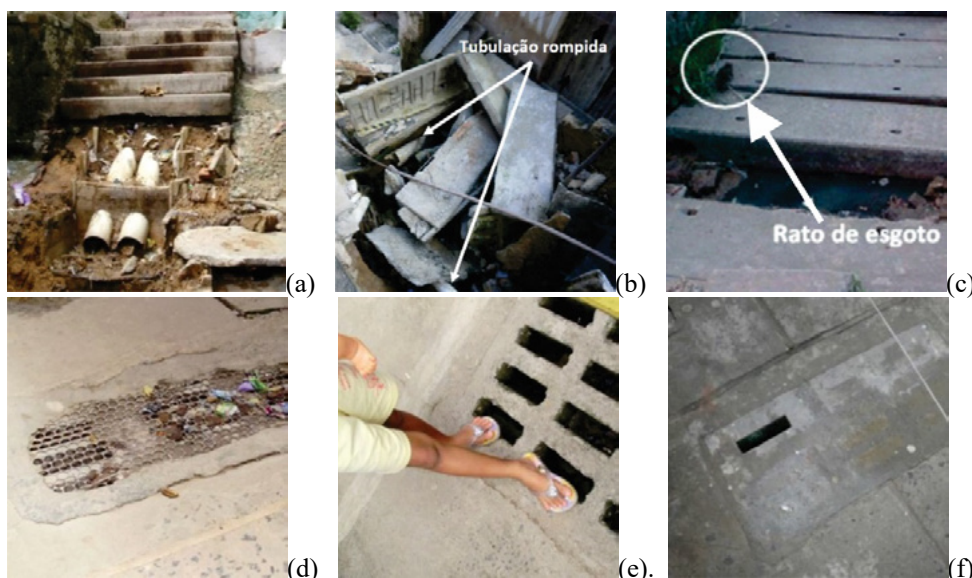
Falhas estruturais em escadarias drenantes em Salvador-BA e outros problemas relacionados.
